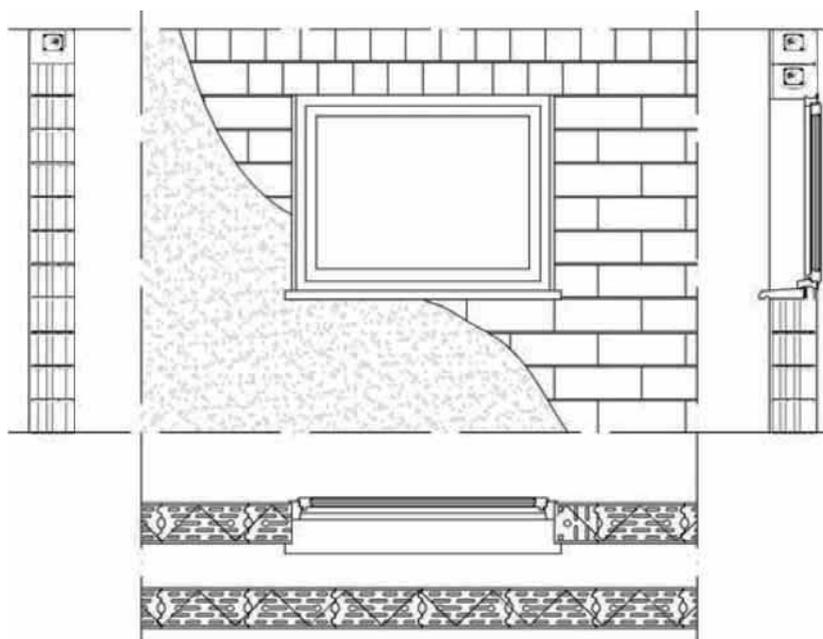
Detalle ventana en muro de 1 hoja de fábrica de bloque aligerado tipo Arliblock: alzado, plantas y secciones.
